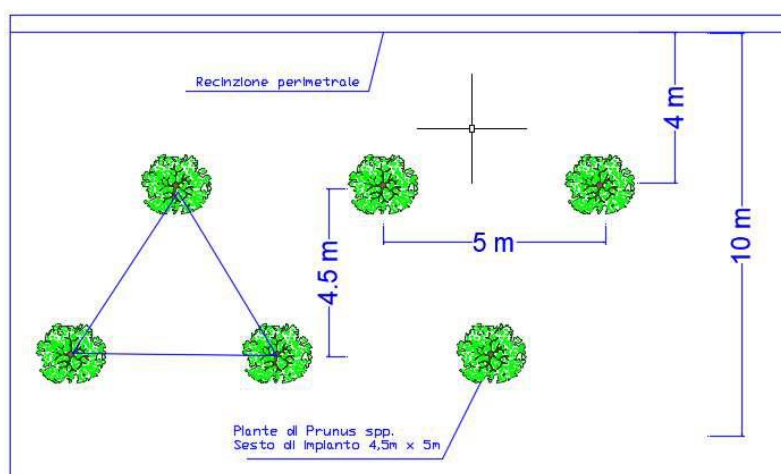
fascia arborea perimetrale e il sesto d’impianto
